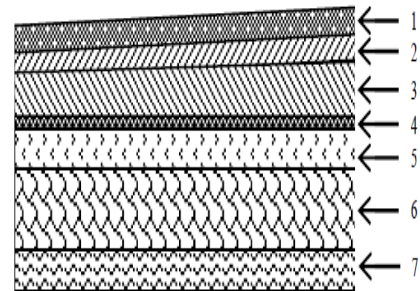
Coupe verticale du dernier plancher (terrasse inaccessible).
